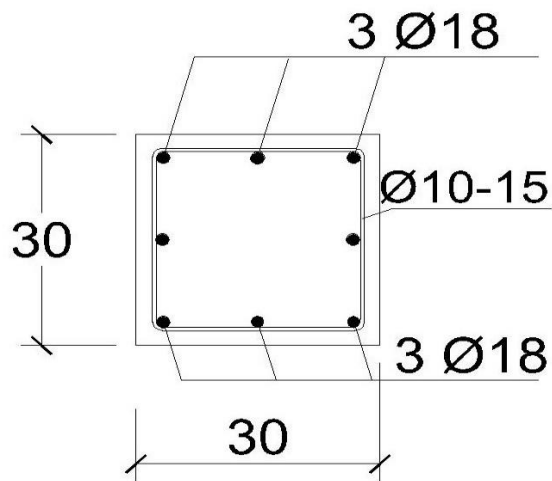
Denah Kolom Lantai 1 Sampai 5
